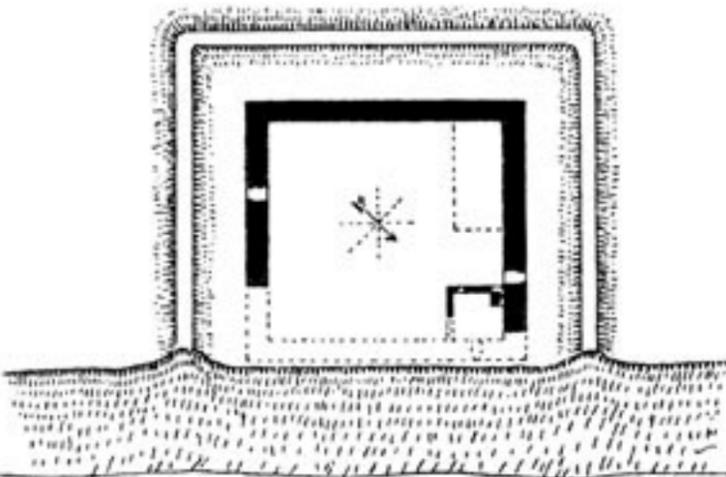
Grundriss der Burg Wolkenburg/Valkenberg (LV) nach TUULSE 1942.
